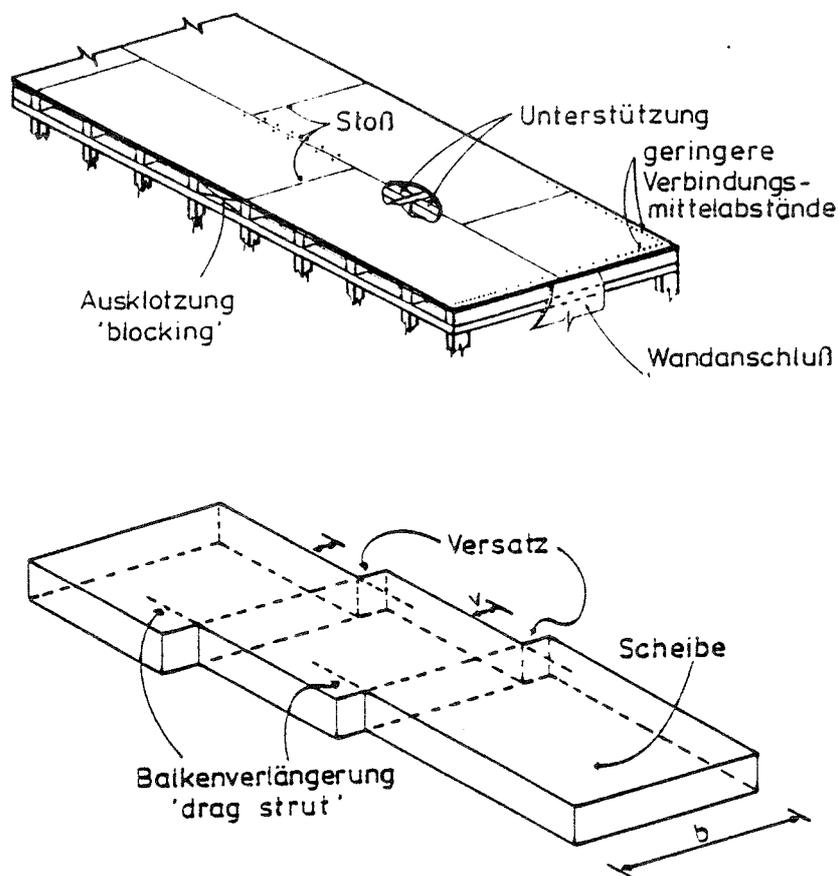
Ausklotzen ('blocking') und Balkenverlängerung ('drag struts')
